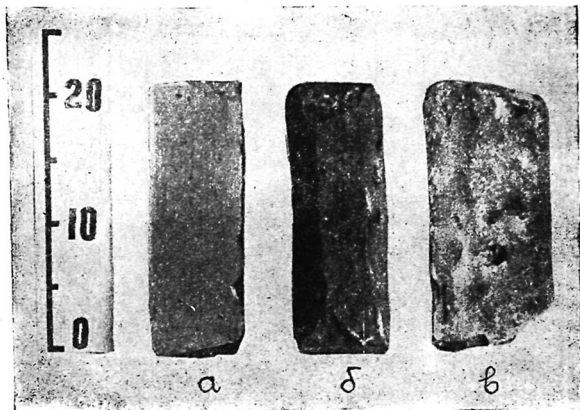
Мавзолей Тюрябек-Ханым. Изразец из облицовки купола: а) вид глазурованной поверхности, б) вид обратной стороны, в) боковой вид.
